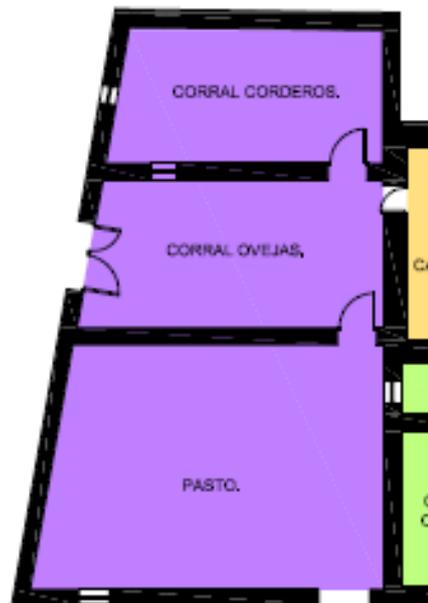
Plano distribución corral ovejas en Planta Baja.
